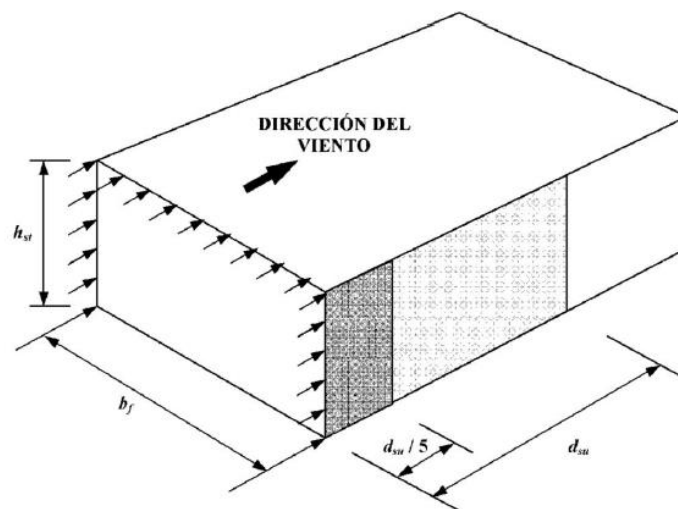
Zonas no permitidas en fachadas laterales para colocación de aberturas de admisión (UNE 23585:2017)
